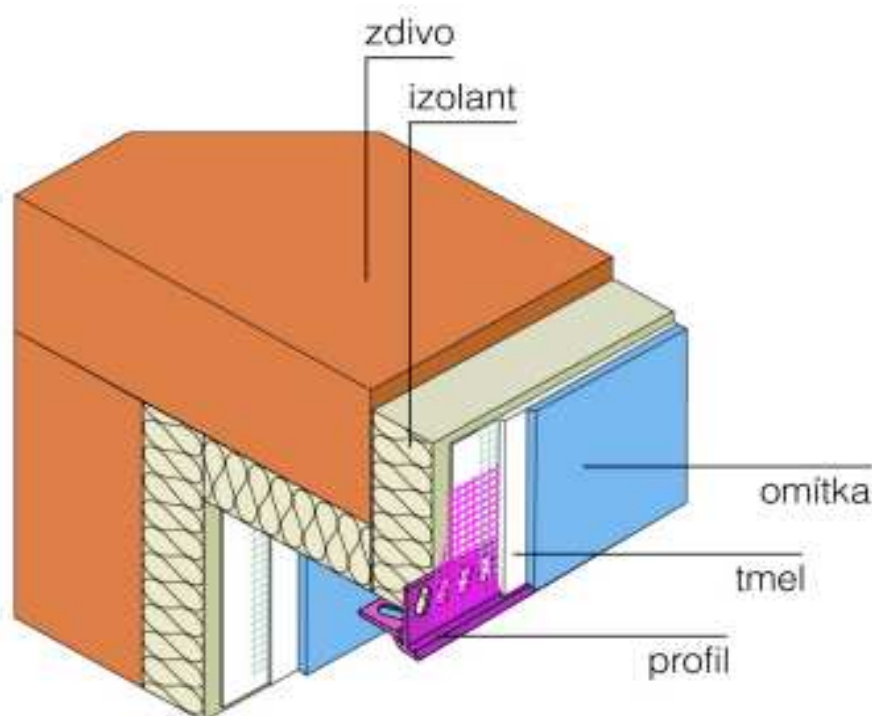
Schématický detail - kotvení izolantu ve zdivu
